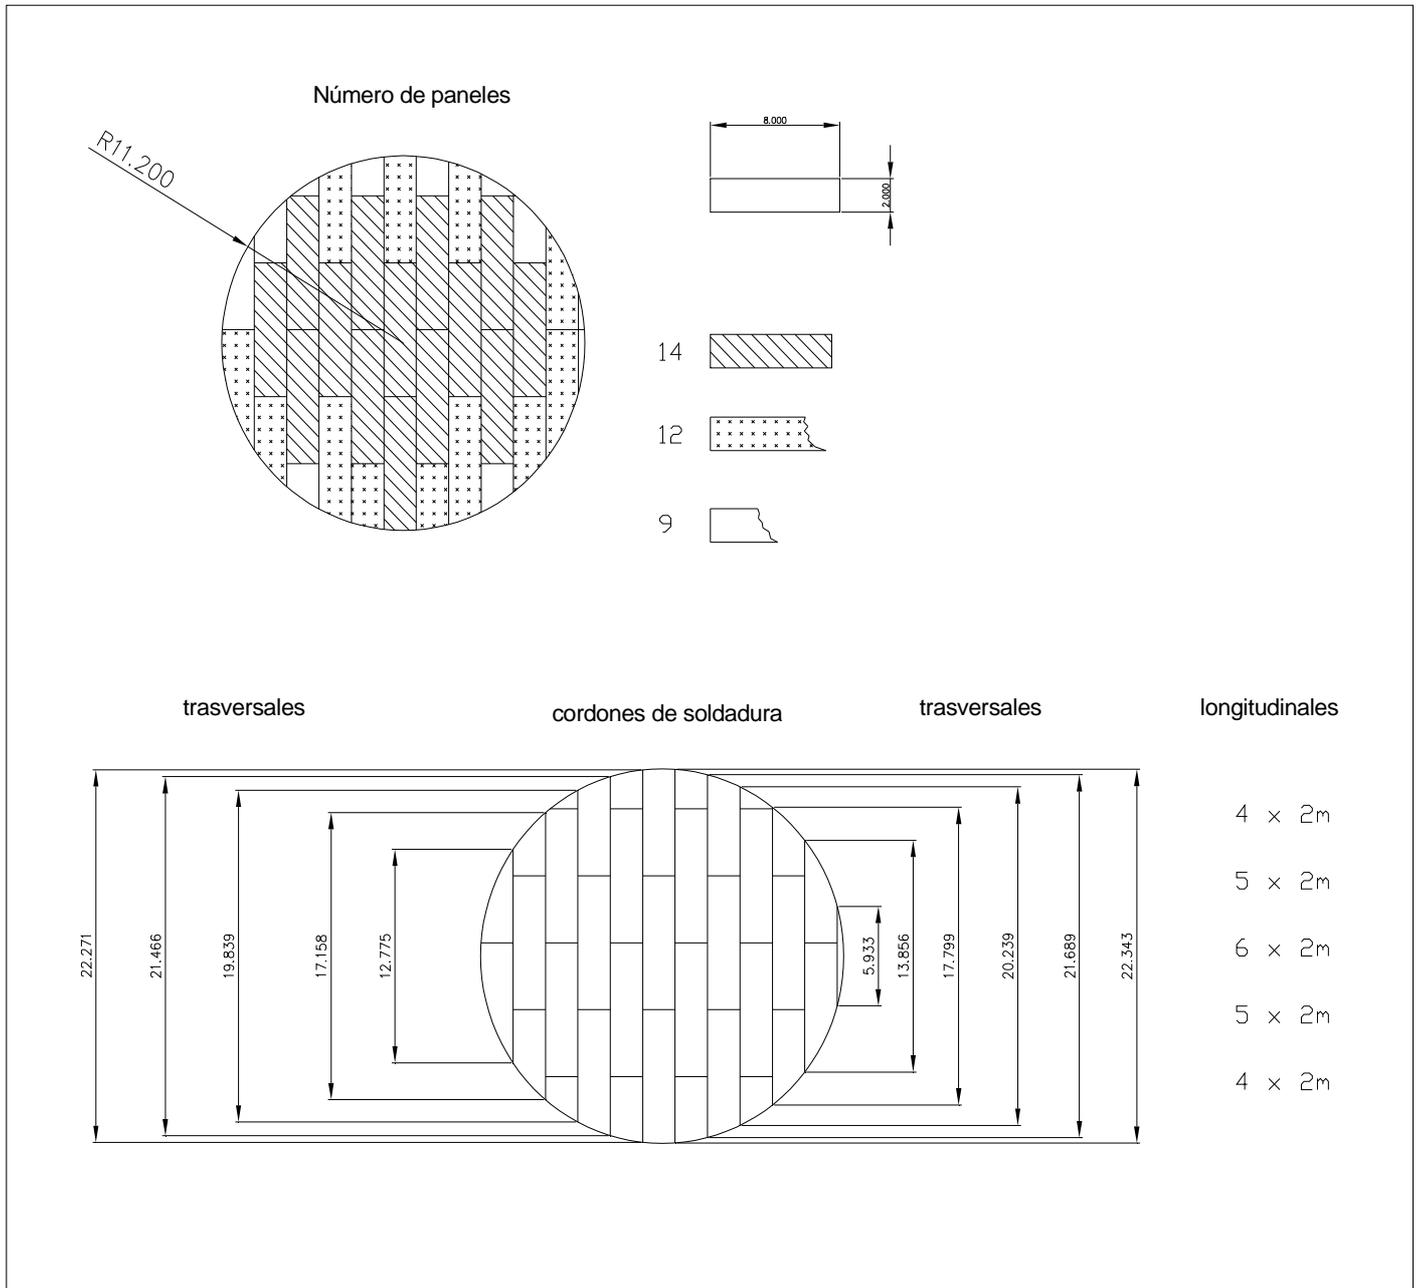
Soldaduras y fondo del tanque N°2 .
